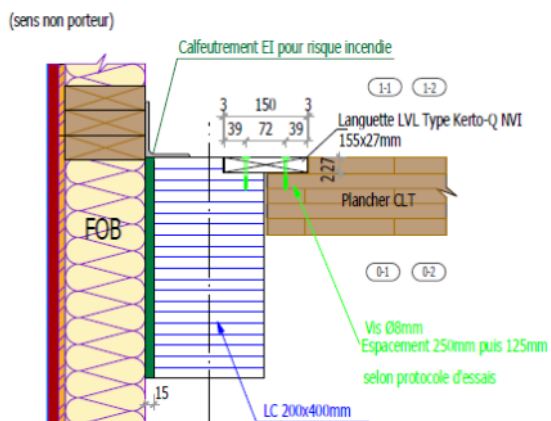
Vue des jonctions en T plancher façade entre le R+1 et le R+2.
